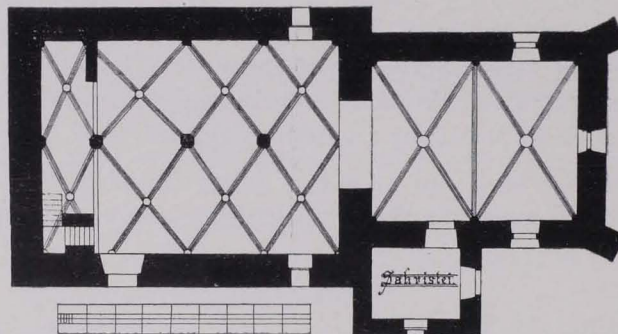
Klein-Zwettl, Filialkirche, Grundriß 1:250 (S. 19)
